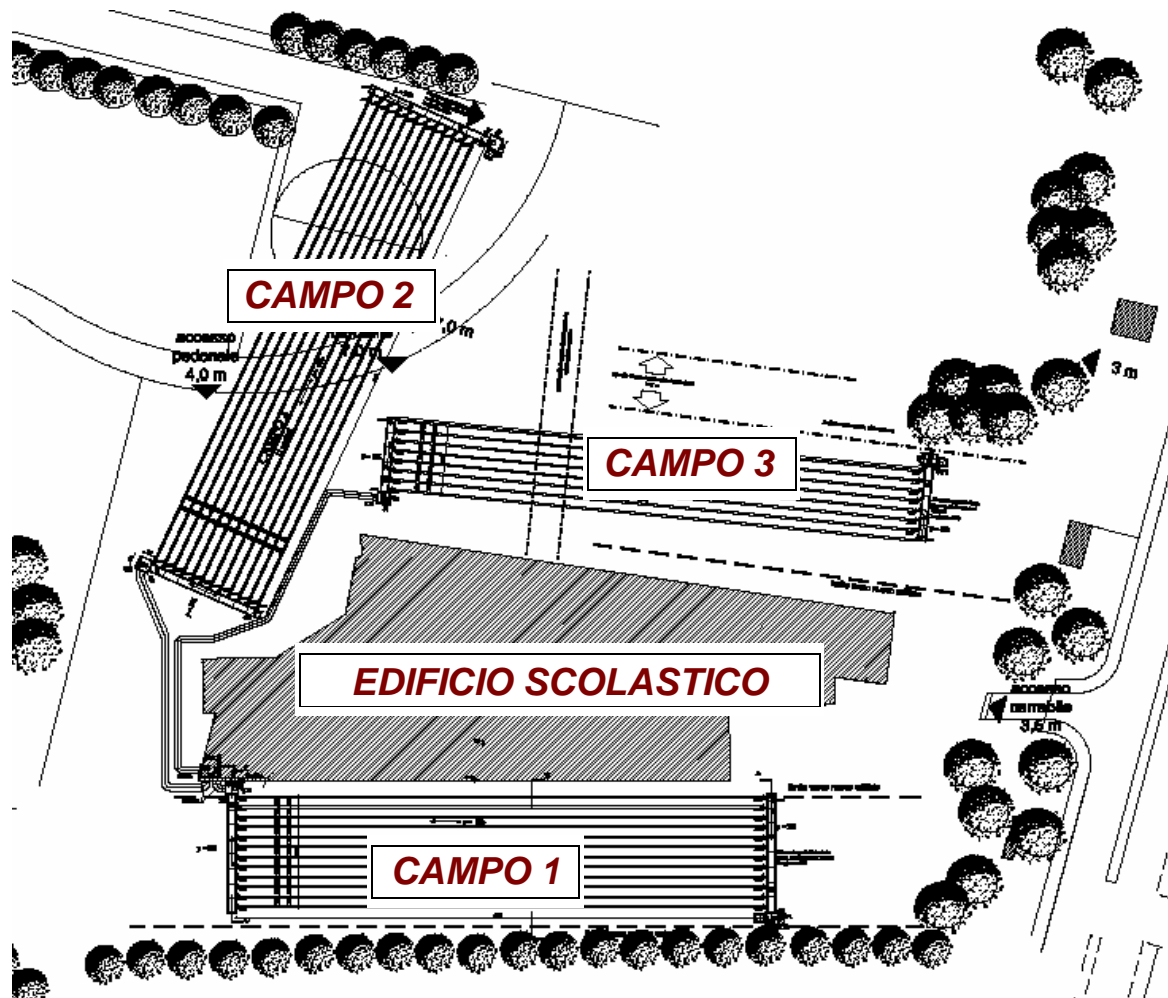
Schema della distribuzione planimetrica del sistema di scambio geotermico
